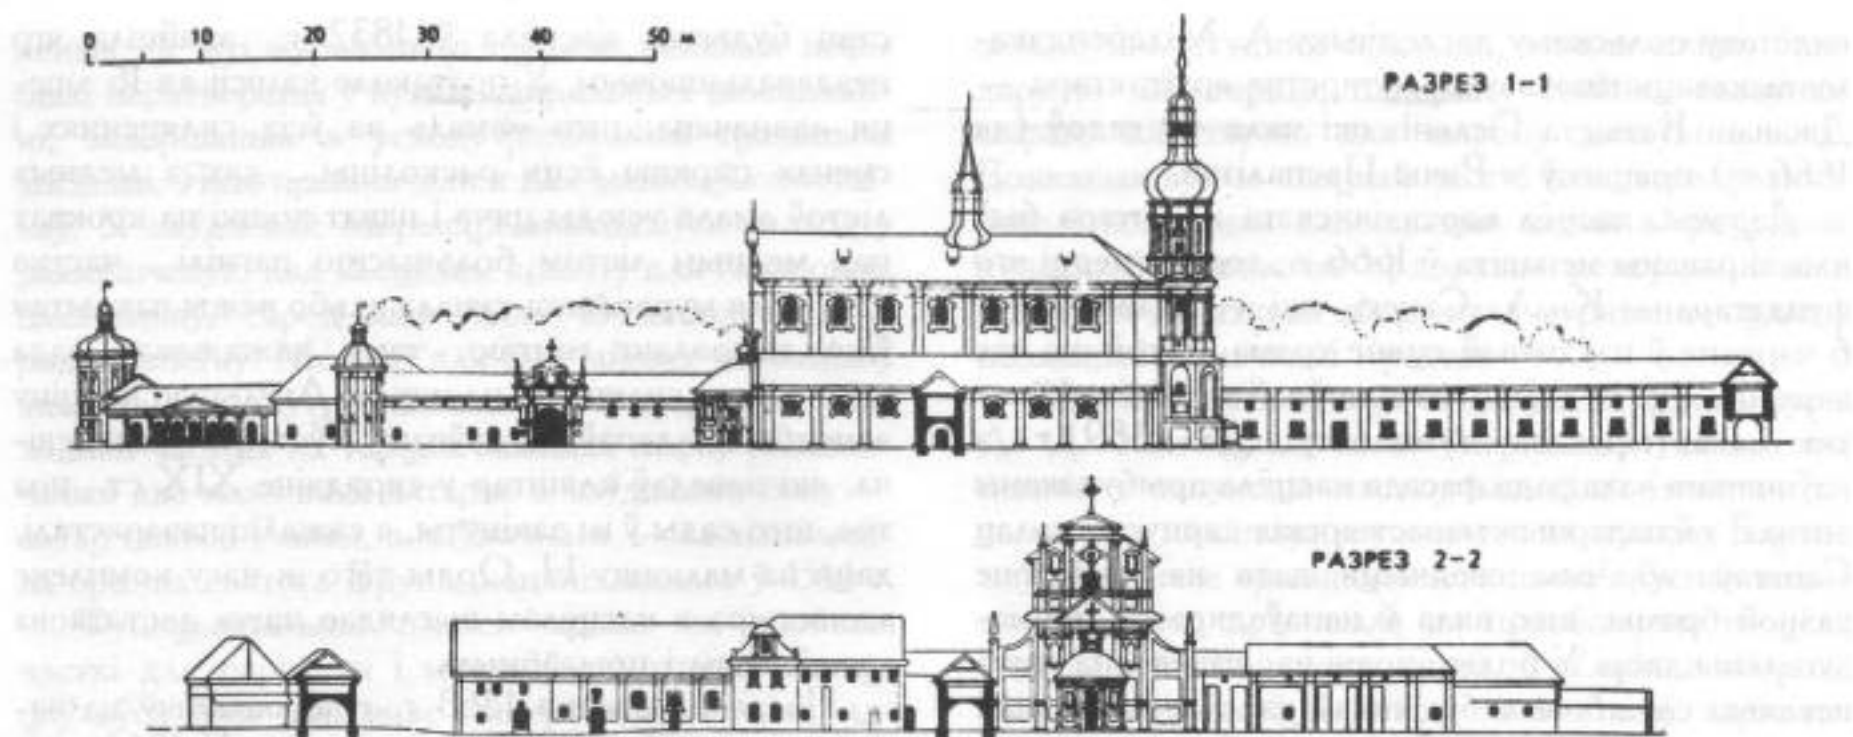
Касцёл і кляштар картэзіянцаў у Бярозе. Бакавы фасад. Галоўны фасад
